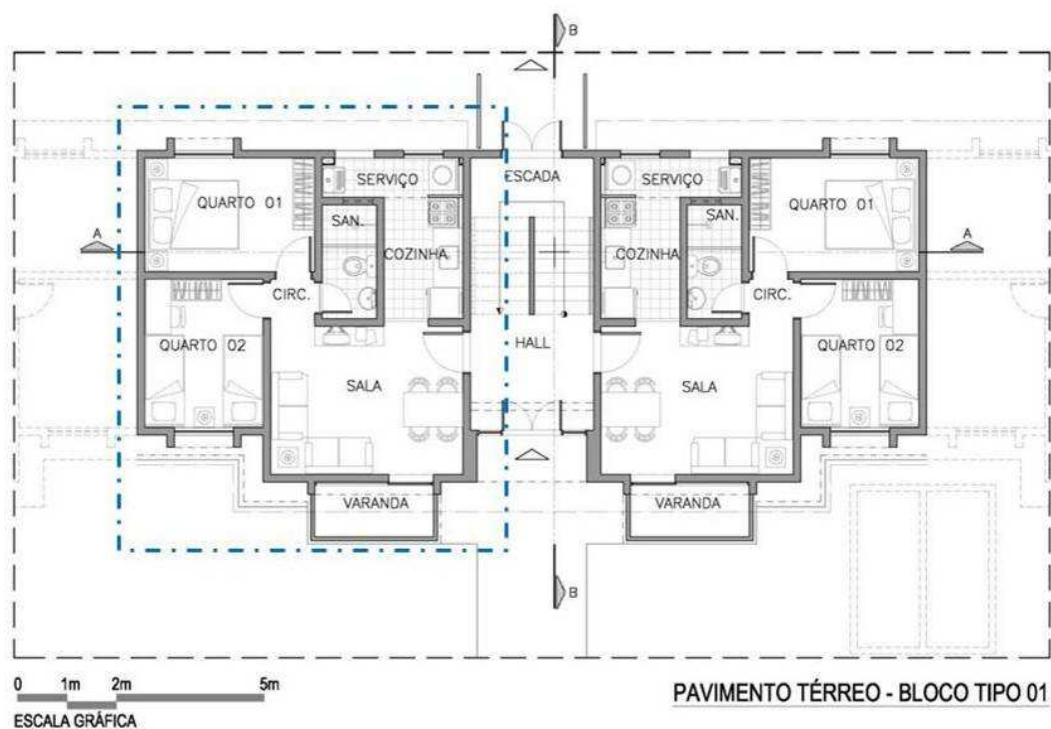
Planta do pavimento térreo do Bloco Tipo 1. Fonte: FFA.
